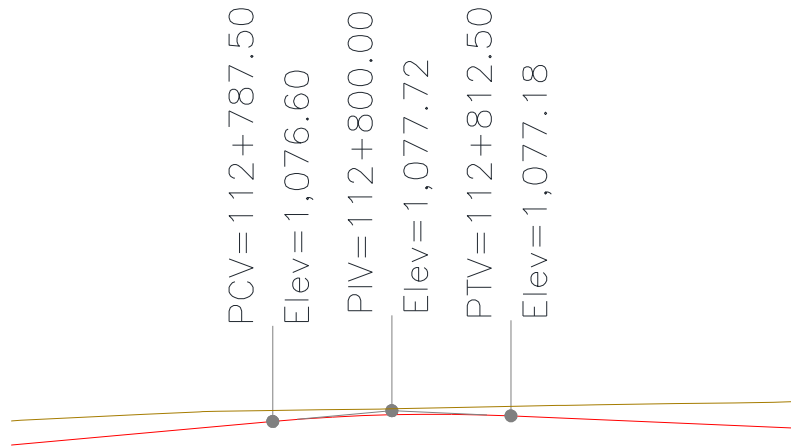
Propuesta de subrasante para el proyecto de alineamiento vertical. Fuente: Propia.
